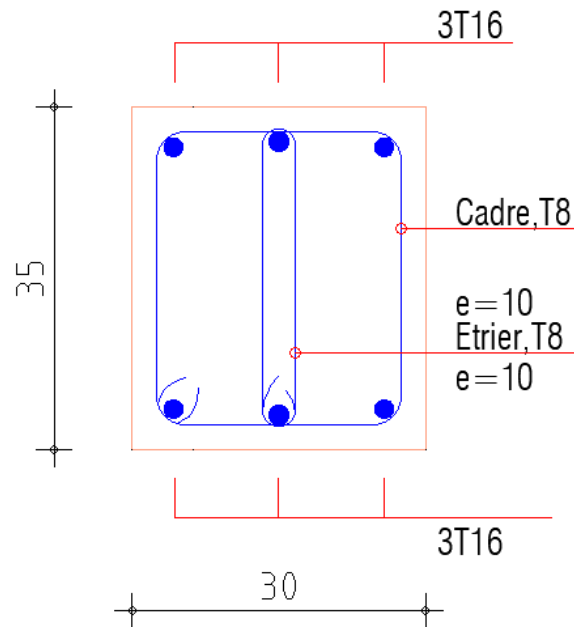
Ferrailage de poutre de chaînage RDC → terrasse (travée).
